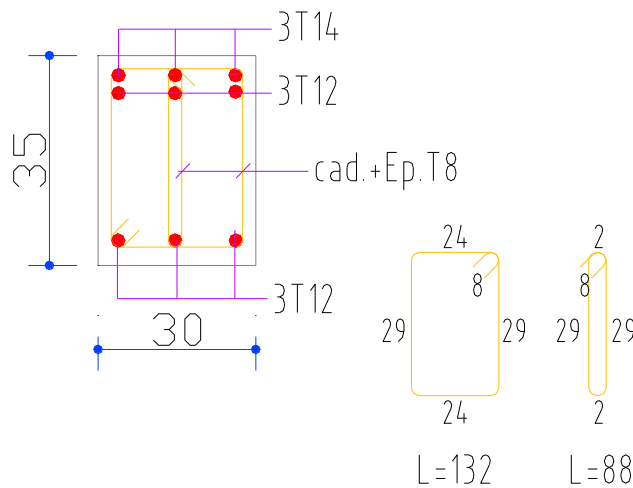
Ferrailage des poutres secondaires au niveau d'appui de 4^{ème} à 7^{ème} étage.
